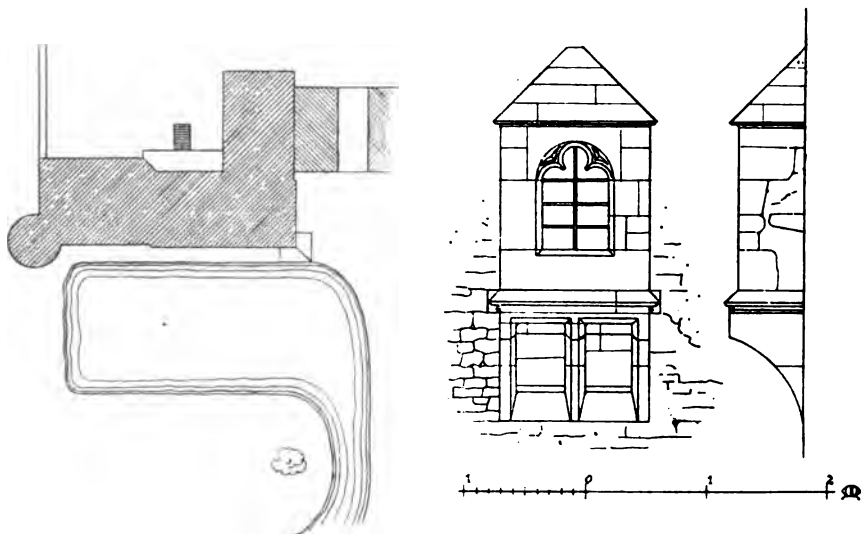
Burg Langendorf. Lageplan und Erker am Wohnhaus.
